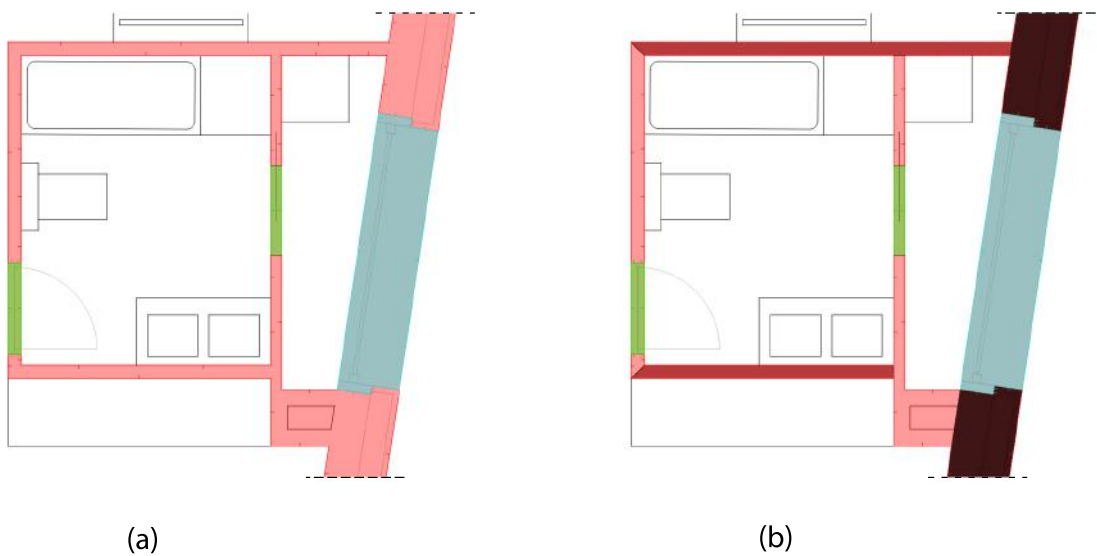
Unterteilen der aufgefundenen Wandflächen. Grafik (a) zeigt einen Ausschnitt eines Grundrissplans mit detektierten Wandöffnungen und Wänden. Wandflächen lassen sich dabei nicht durch einen geschlossenen Polygonzug beschreiben und müssen in geeignete disjunkte Teilflächen unterteilt werden, wie in Grafik (b) visualisiert.
